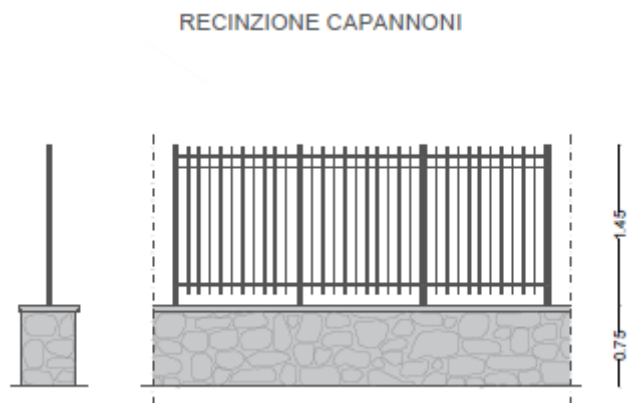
Prospetto muretti a secco di delimitazione lotti
